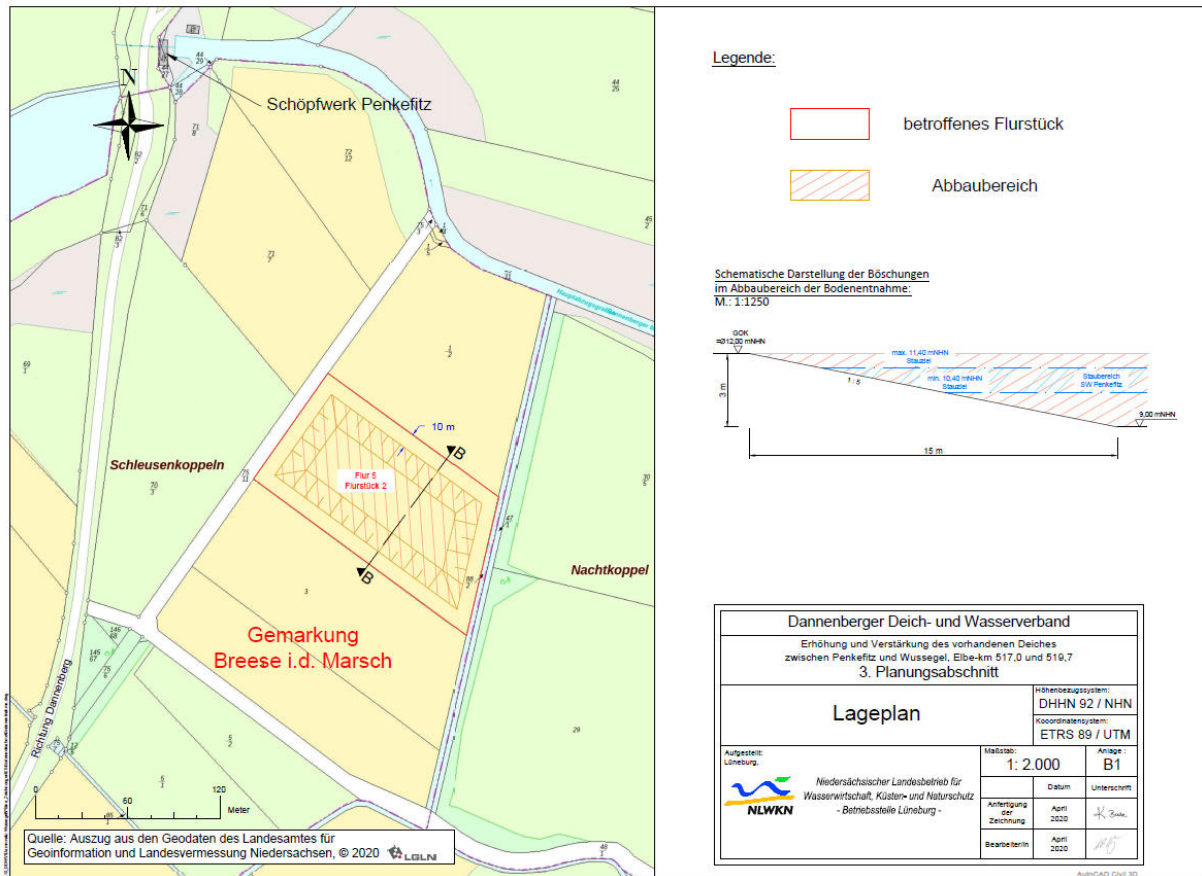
Lageplan der Bodenentnahmestelle 2 für den Planungsabschnitt 3.
